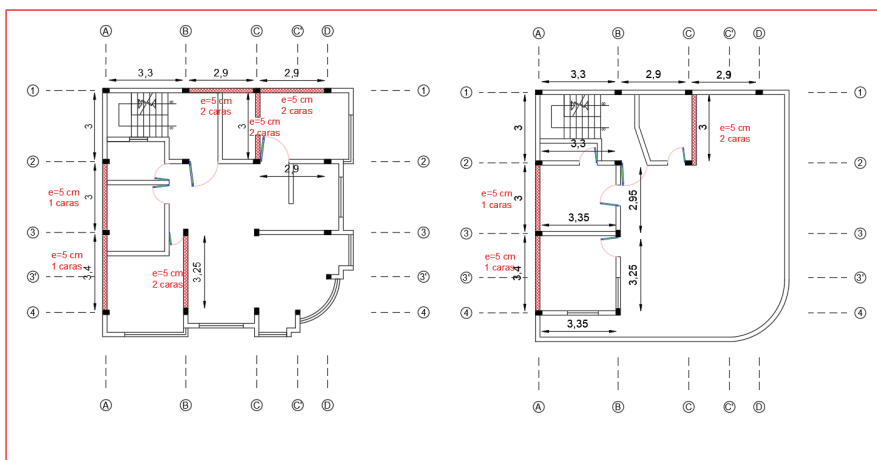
Vista en planta de la ubicación de los enchapes*Figura 8*Vista en planta de la ubicación de los enchapes
